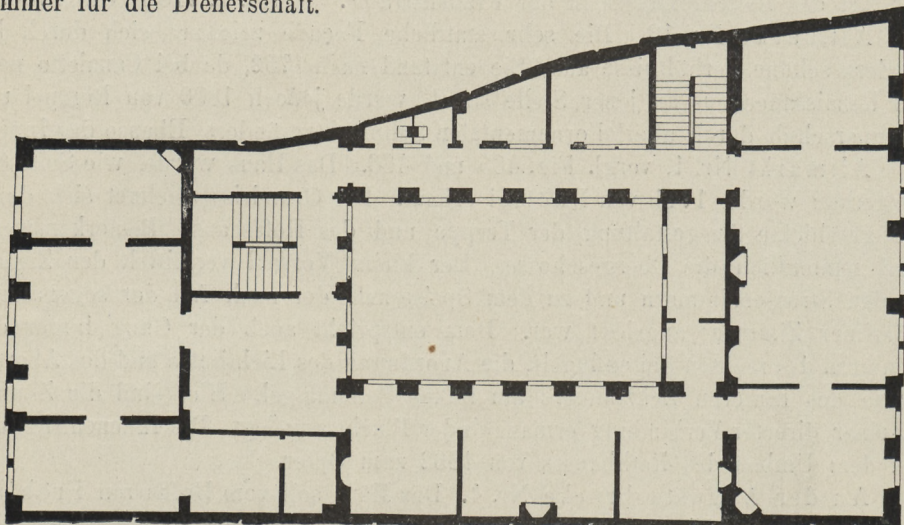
Klostergasse Nr. 4. Grundriss des Obergeschosses.
